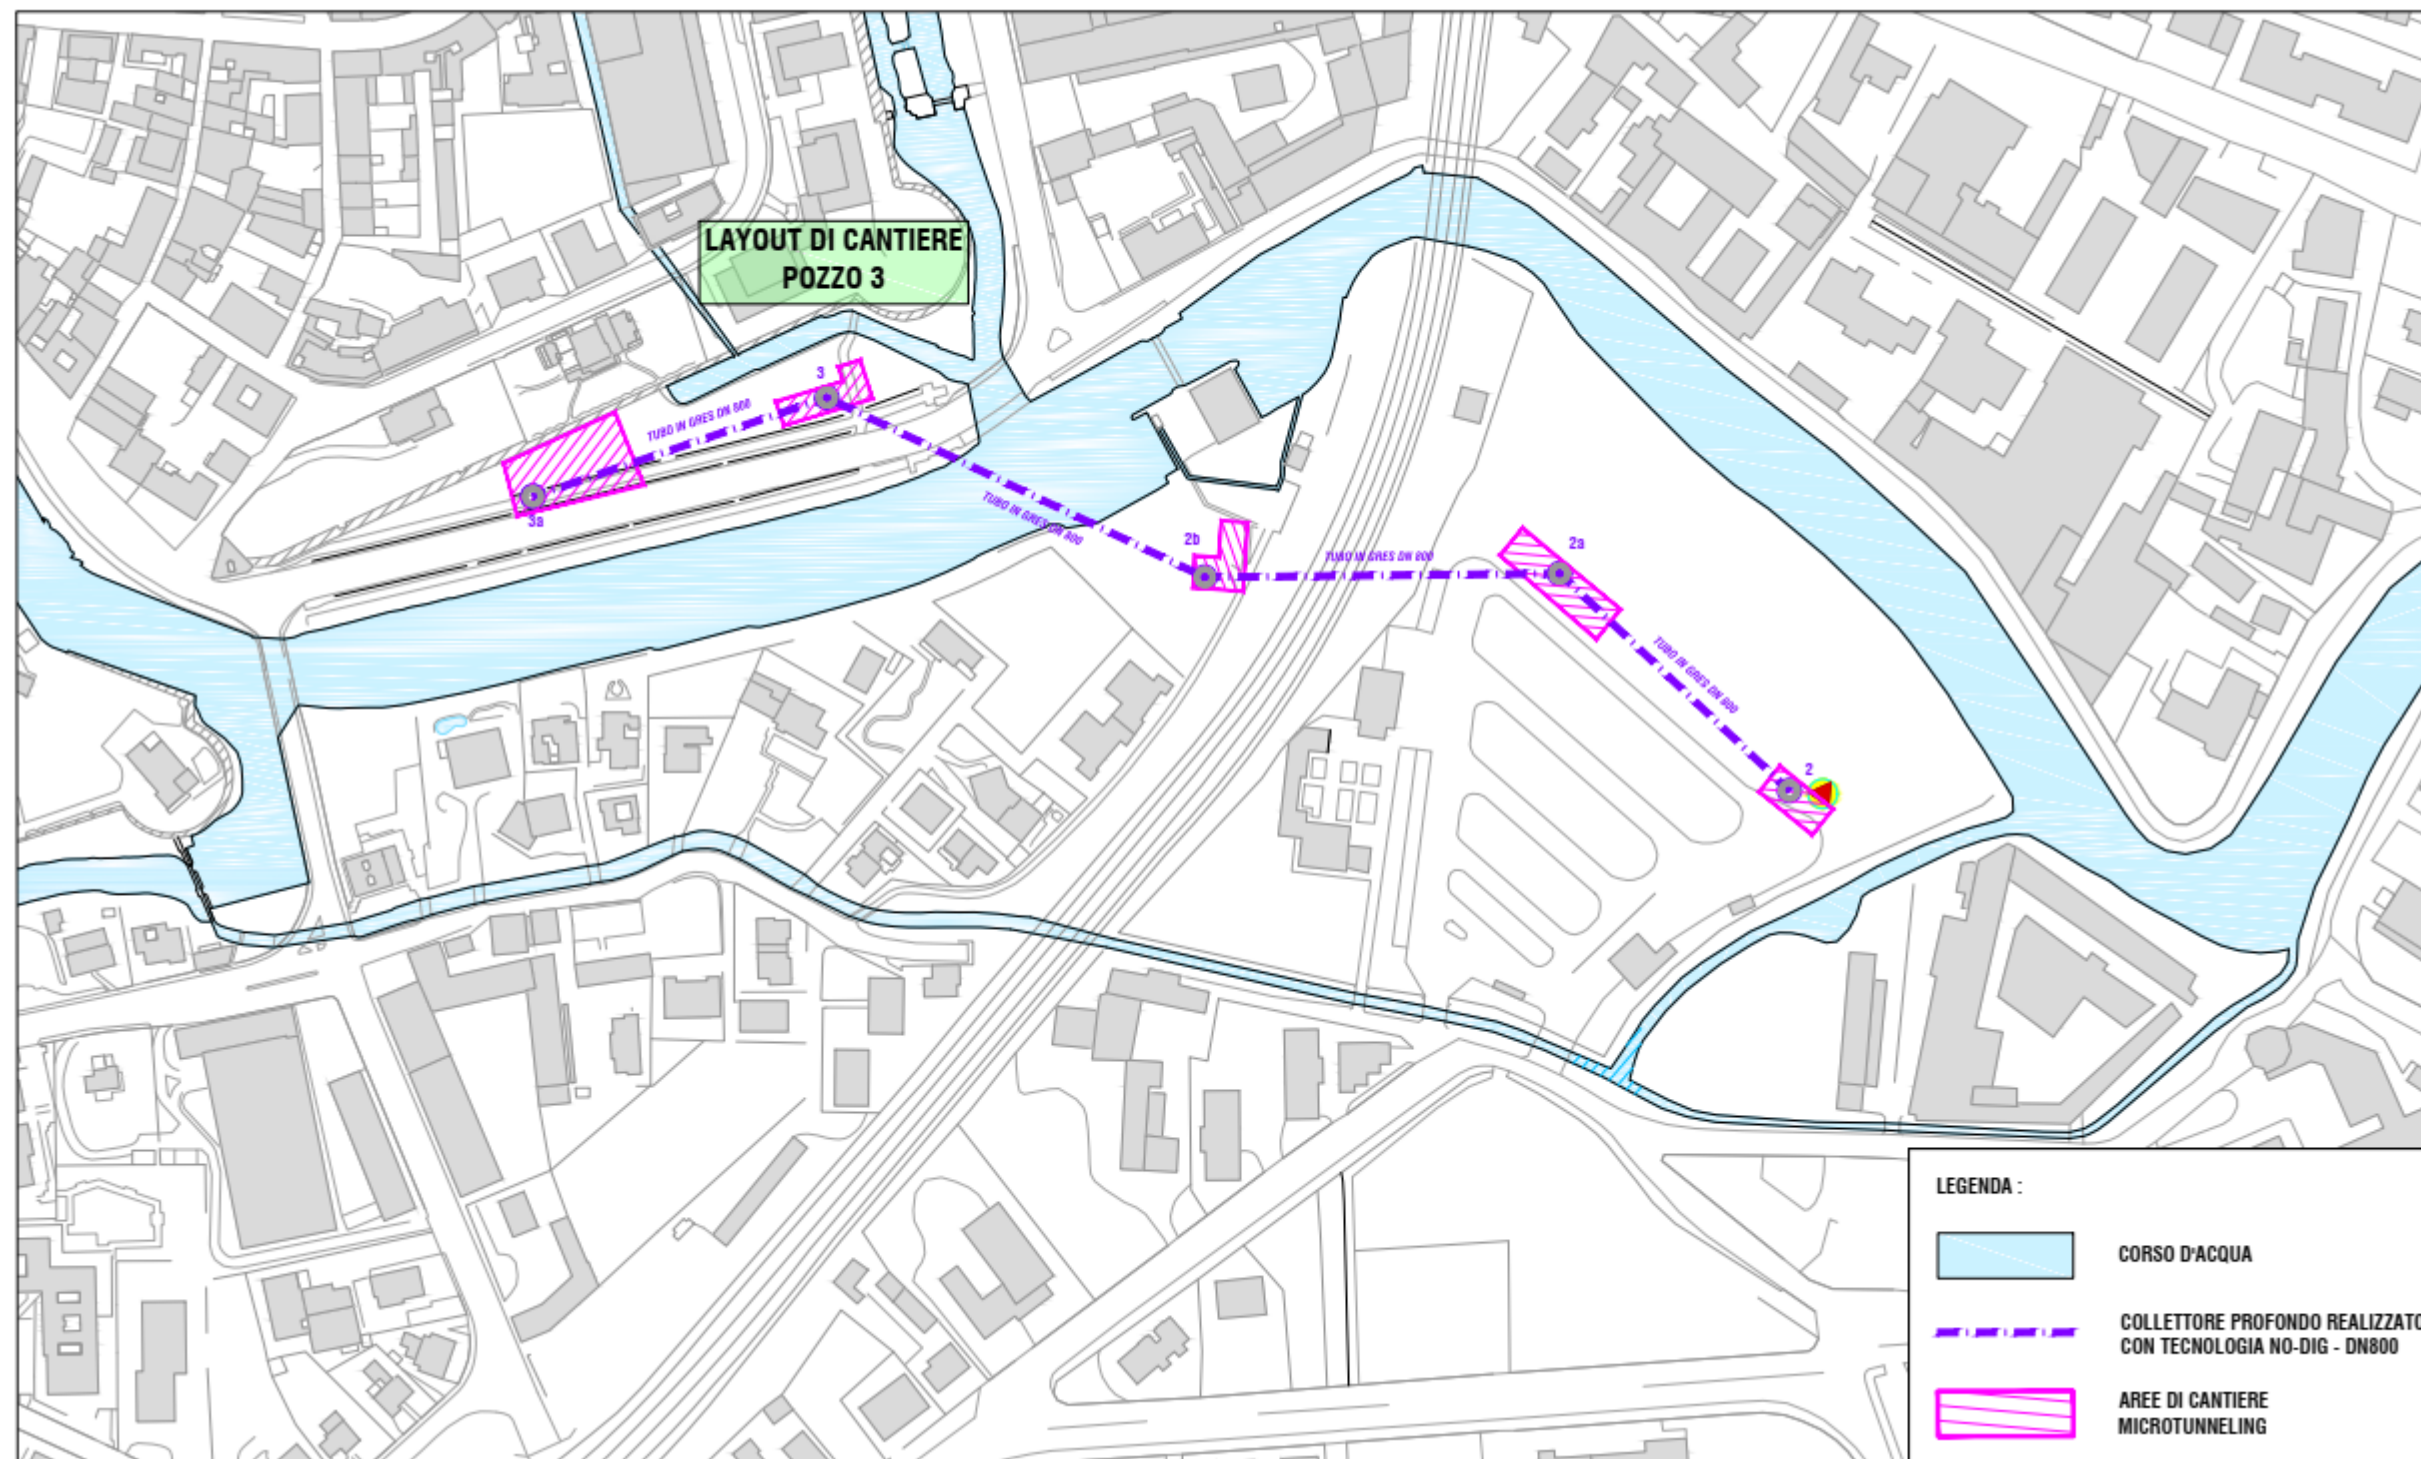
R : Inquadramento planimetrico area cantiere POZZO S03
